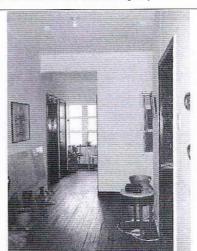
y 24. Vista interior apartamento 402. No se observa daños
